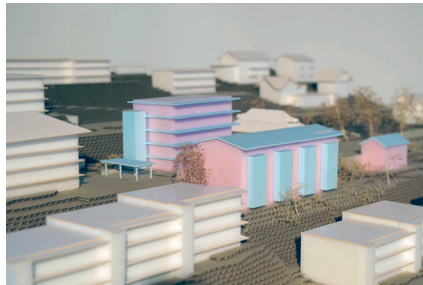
Modellfoto: Mögliche Balkone beim Baubereich A1 (Unterhaus)
